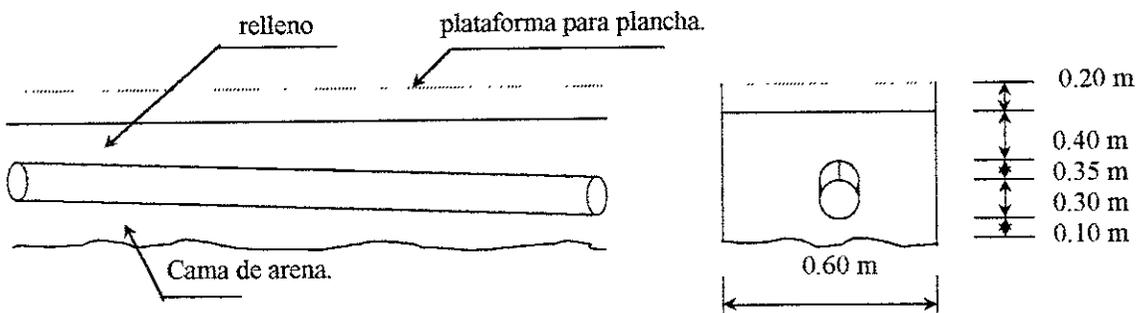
Dimensiones de cepa para tubería de drenaje de 30 cm de diámetro y una pendiente del 1%
